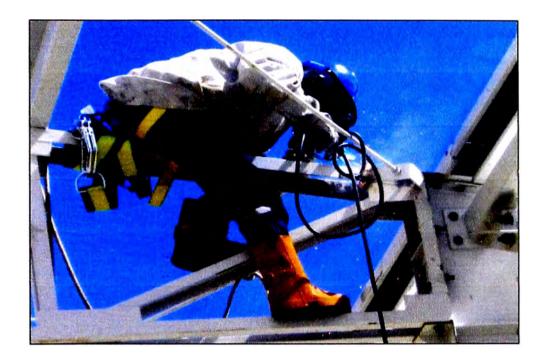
Soldadura de la placa de amarre entre la columna y el tijeral
